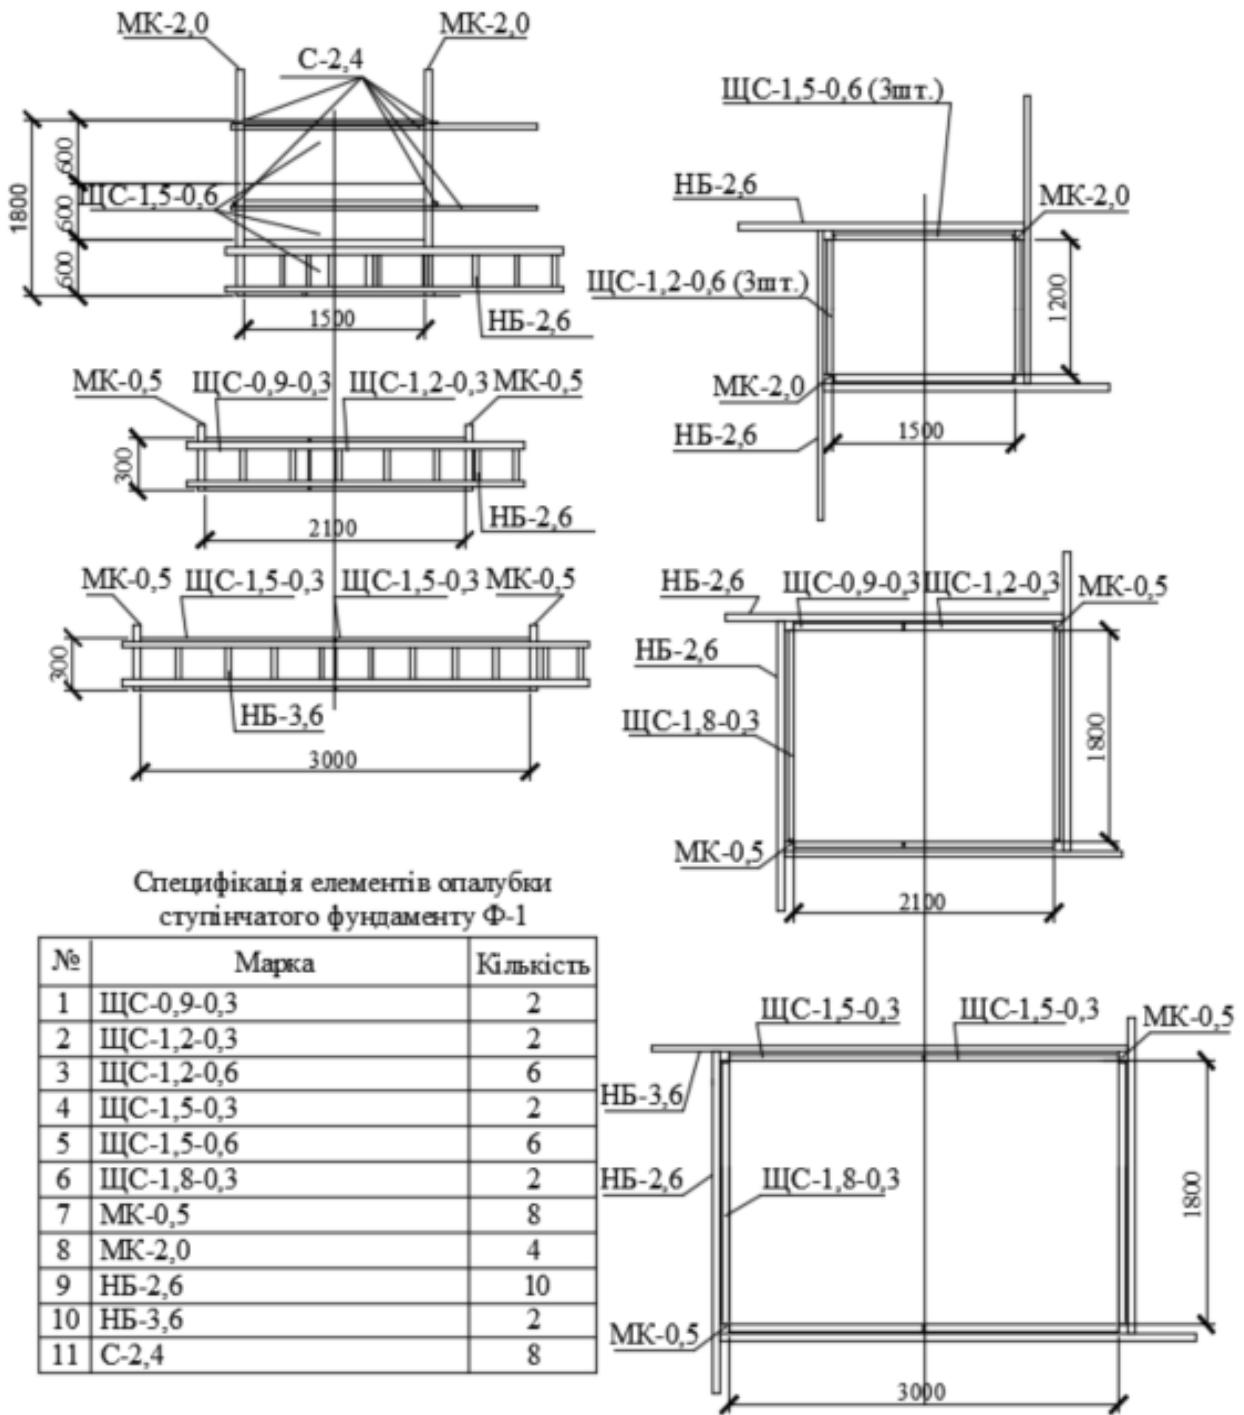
Маркувальна схема ступінчастого фундаменту зі специфікацією елементів опалубки
